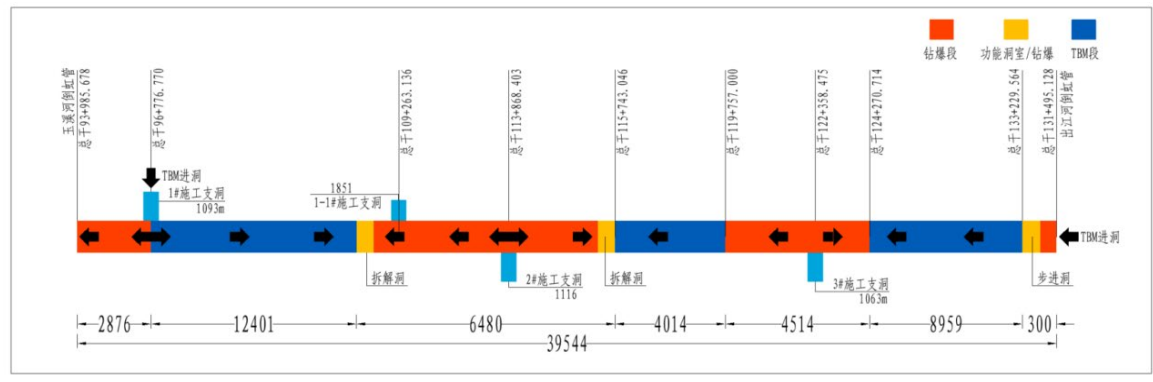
莲花山隧洞施工方案示意图 (TBM+爆破)
